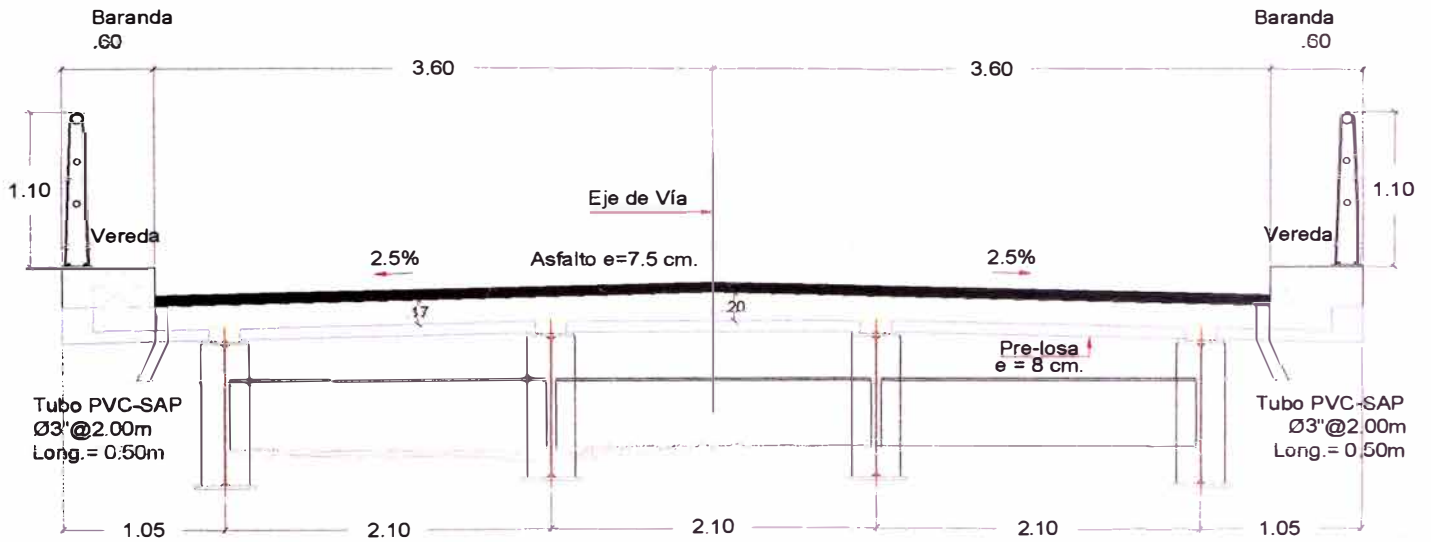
Sección Transversal Típica para Puente de Sección Mixta
